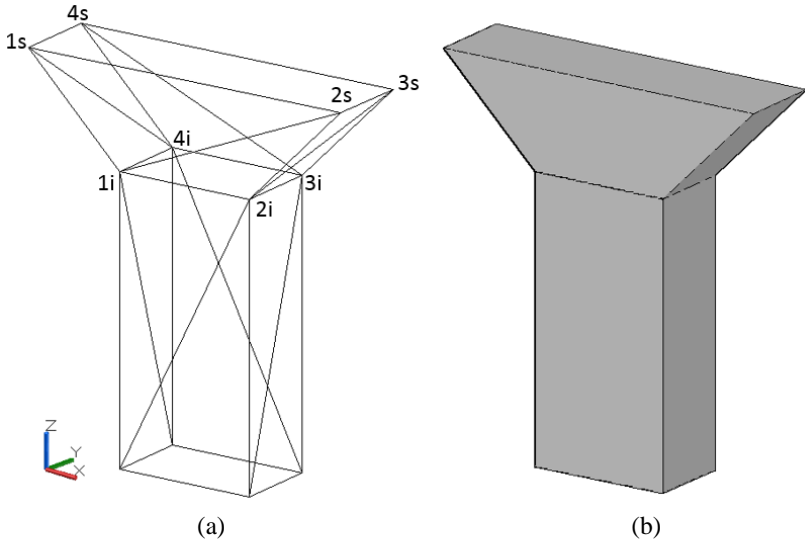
Discretização de um pilar utilizando dois sólidos (a) discretização do pilar (b) idealização do pilar
